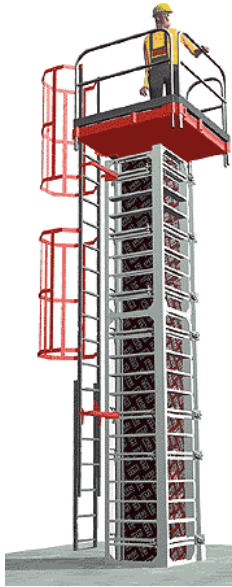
Encofrado de pilar cuadrado metálico.2008.Alsina
